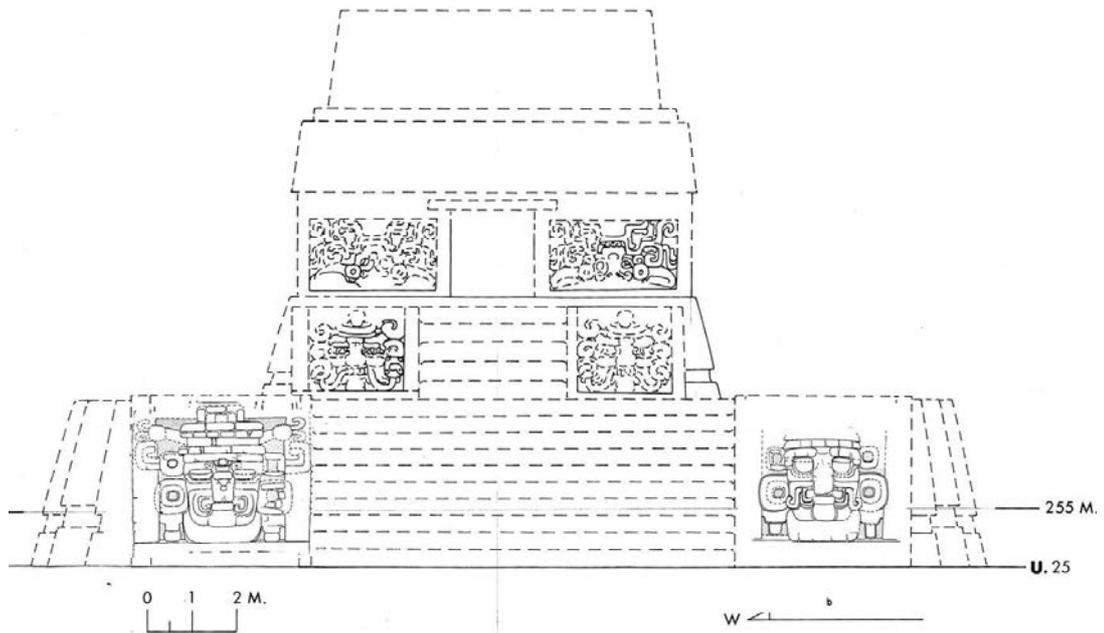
, Estr. 5D-33 2^a y 3^a Fachada Sur
